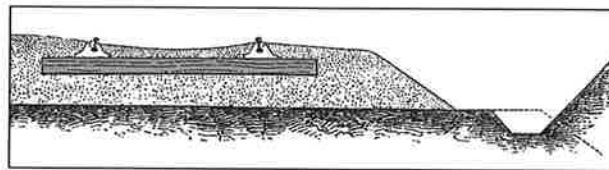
, échelle du plan : 15/1000 : Profil de ballast (Compagnie de l'Est)
